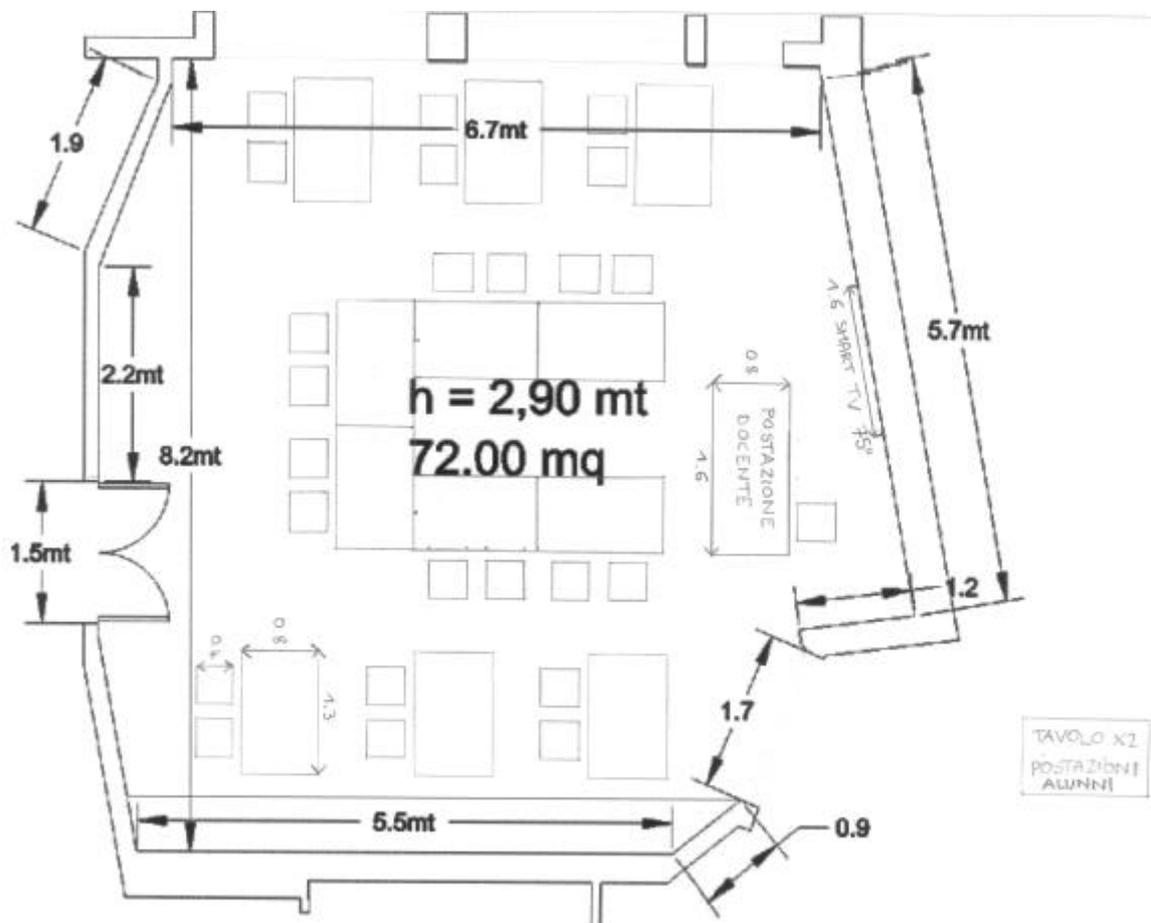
Planimetria con nuova posizione postazioni richiesta dalla Scuola
